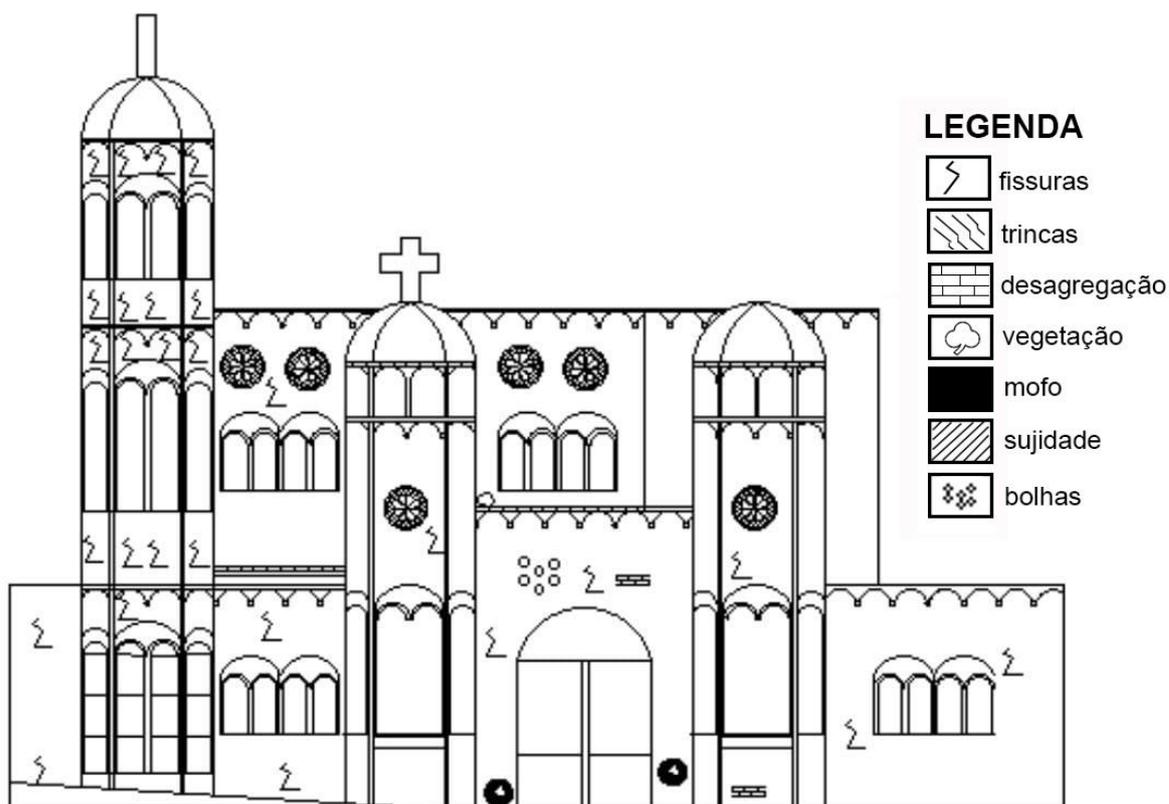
Fissuras e sujidades na fachada Sudeste.
